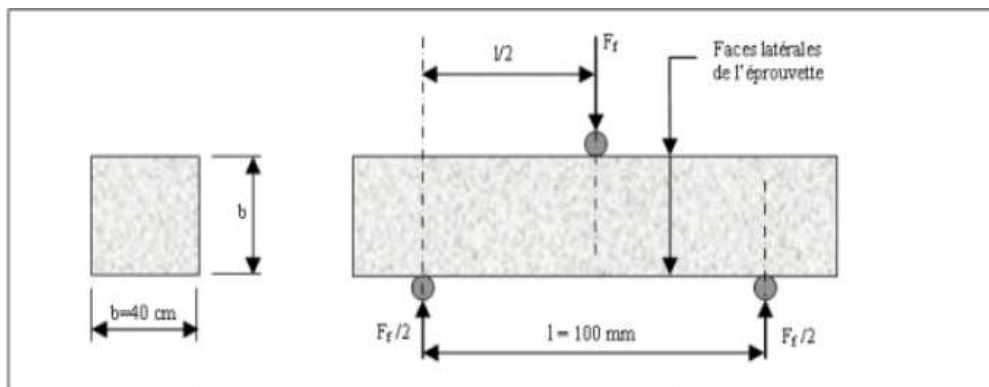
Dispositif pour l'essai de flexion par trois points.
